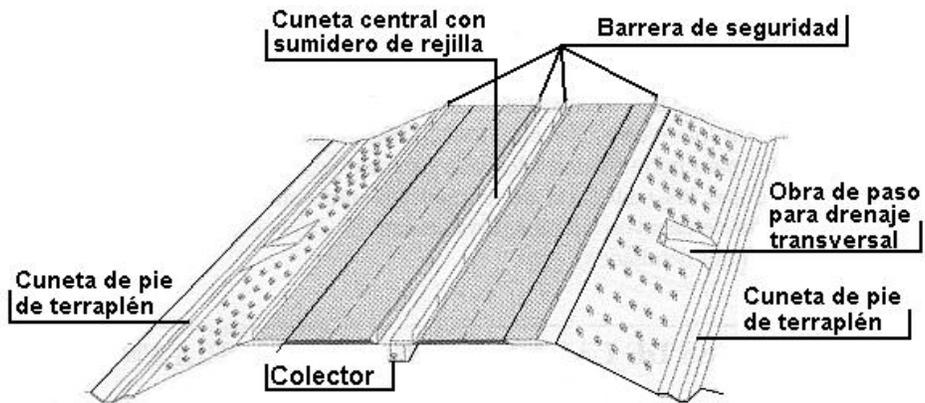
b: Sección Transversal en "Terraplén" en Vía de Calzada Dividida.
